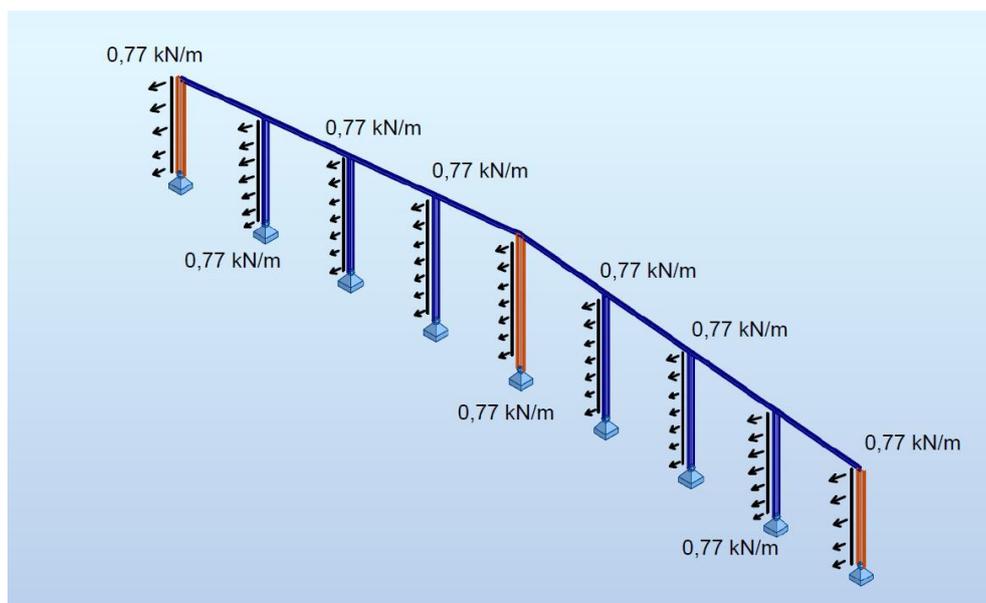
REPRESENTACIÓN PÓRTICO DE FACHADA (PLANO PERPENDICULAR AL PÓRTICO) EN ZONA E PARA CARGAS CON DIRECCIÓN LONGITUDINAL A LA FACHADA
